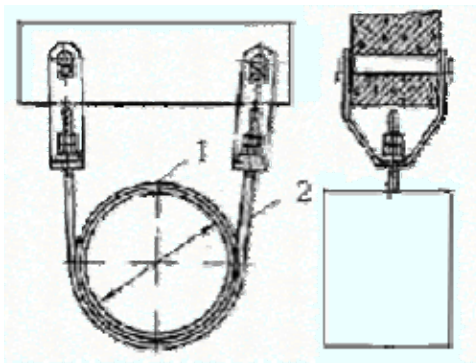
Supratraversare pe sub un pod din beton armat
